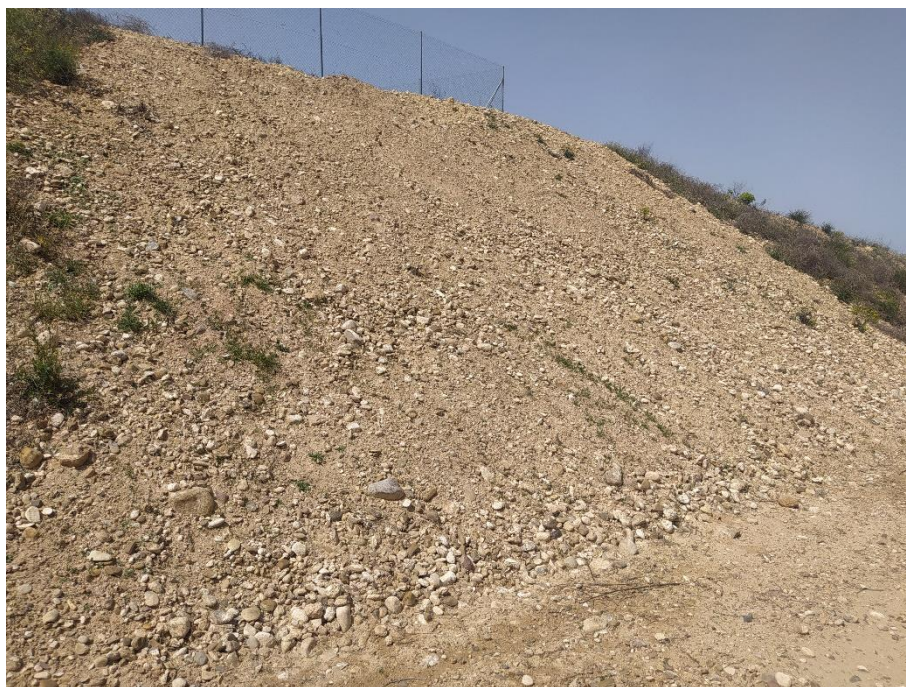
Estado del talud exterior situado en el extremo Noreste de la planta fotovoltaica, tras los trabajos de reconstrucción realizados
